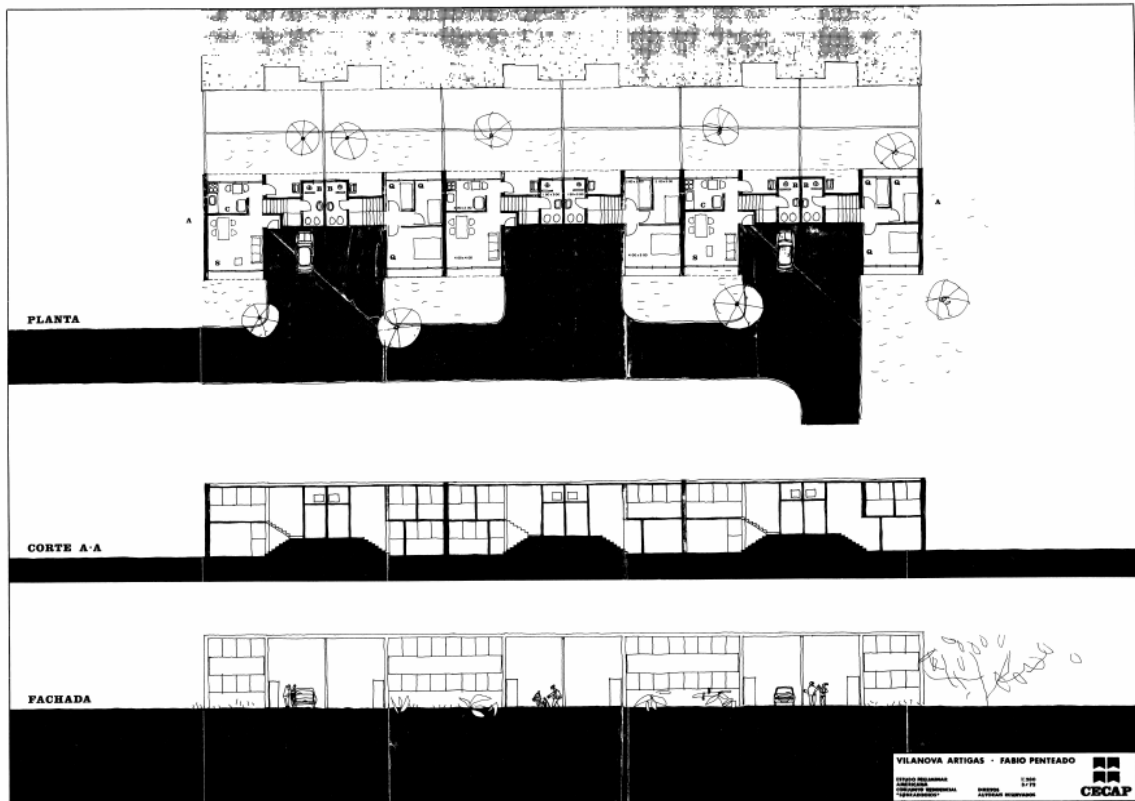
Conjunto CECAP Americana/SP, 1972 - Estudo Preliminar - Implantação
